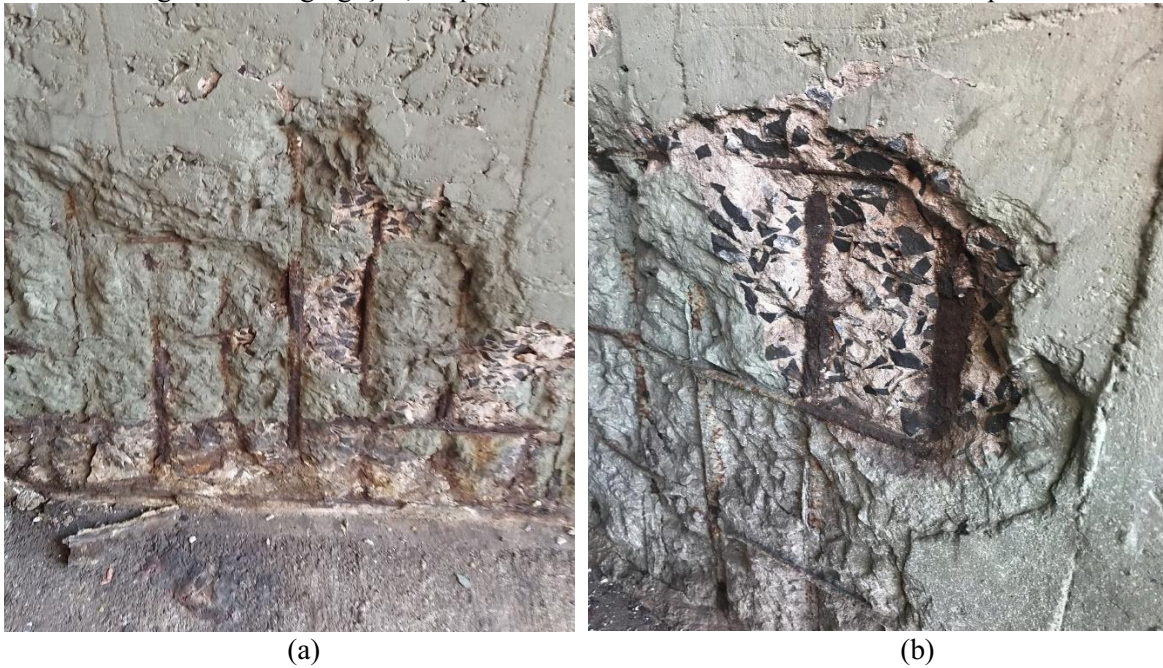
Segregação, deslocamento com exposição e corrosão da armadura na base de um pilar
